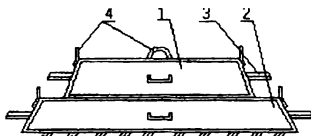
Неразъемная блок-форма для бетонирования фундаментов
